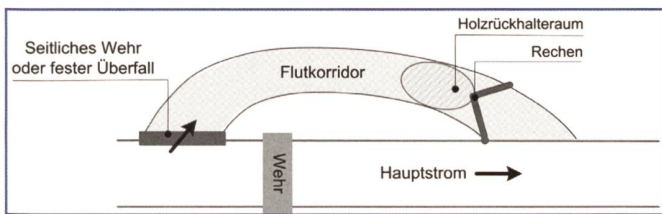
Schematische Darstellung des Massnahmentyps Wehr (Grundriss).
